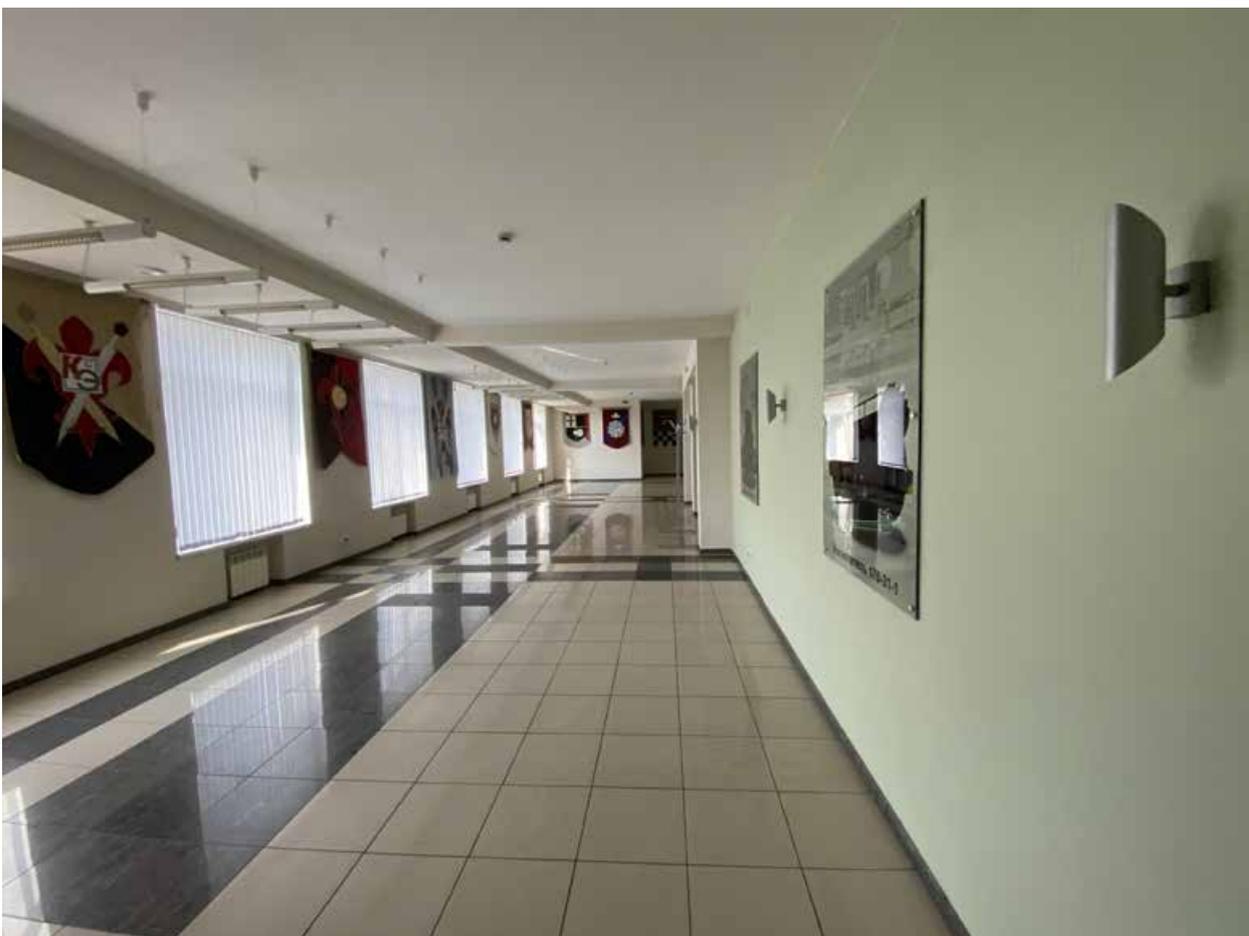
4 этаж. Помещение 10-Н(15-19).
